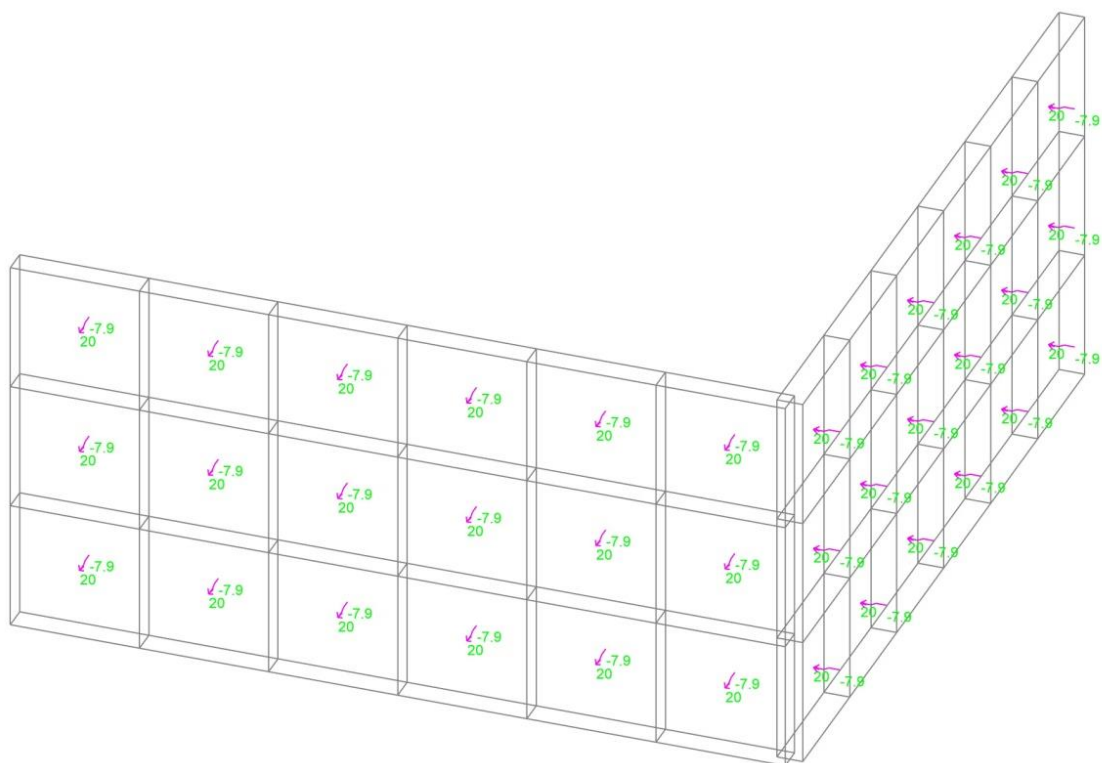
Расчетные температурные нагрузки при охлаждении конструкции (разработано автором)
